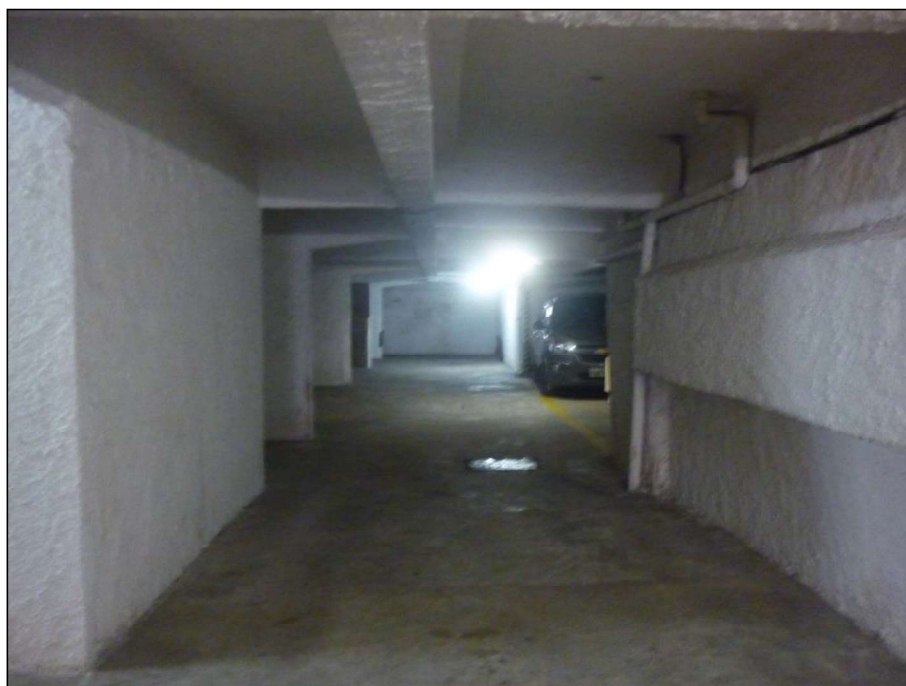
Vista do subsolo do Edifício Res Verde Mar.
